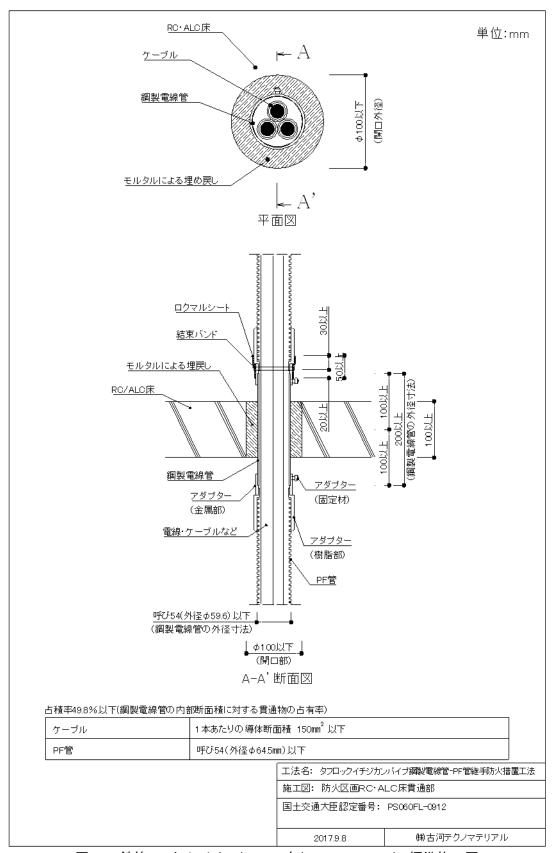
鉄筋コンクリート(RC)·ALC 床(PS060FL-0912) 標準施工図
